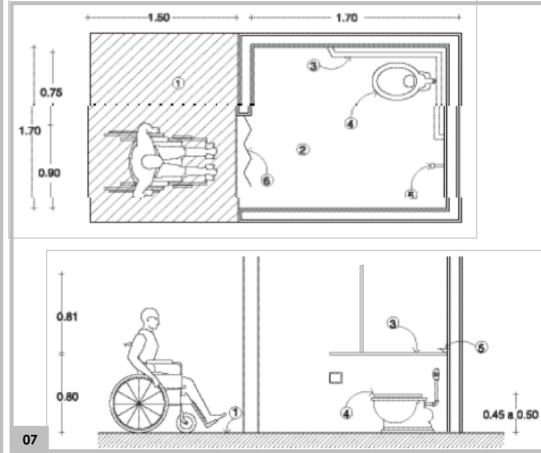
Planta de ejemplo de sanitarios para discapacitados. IMAGEN 07 Planta y alzado de ejemplo de sanitarios para discapacitados.
